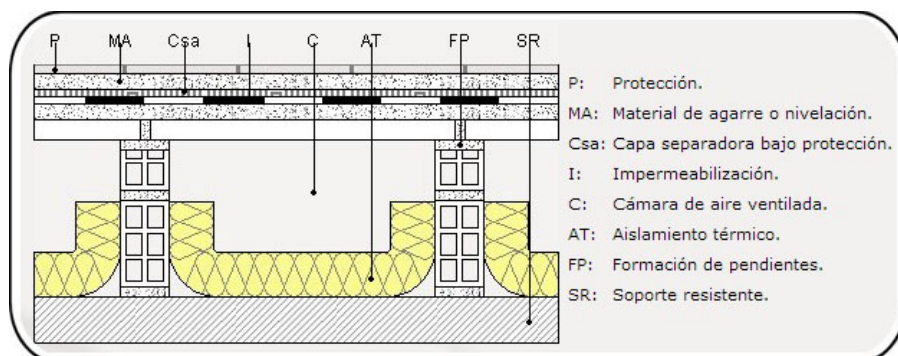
Detalle esquemático de una cubierta ventilada transitable.
